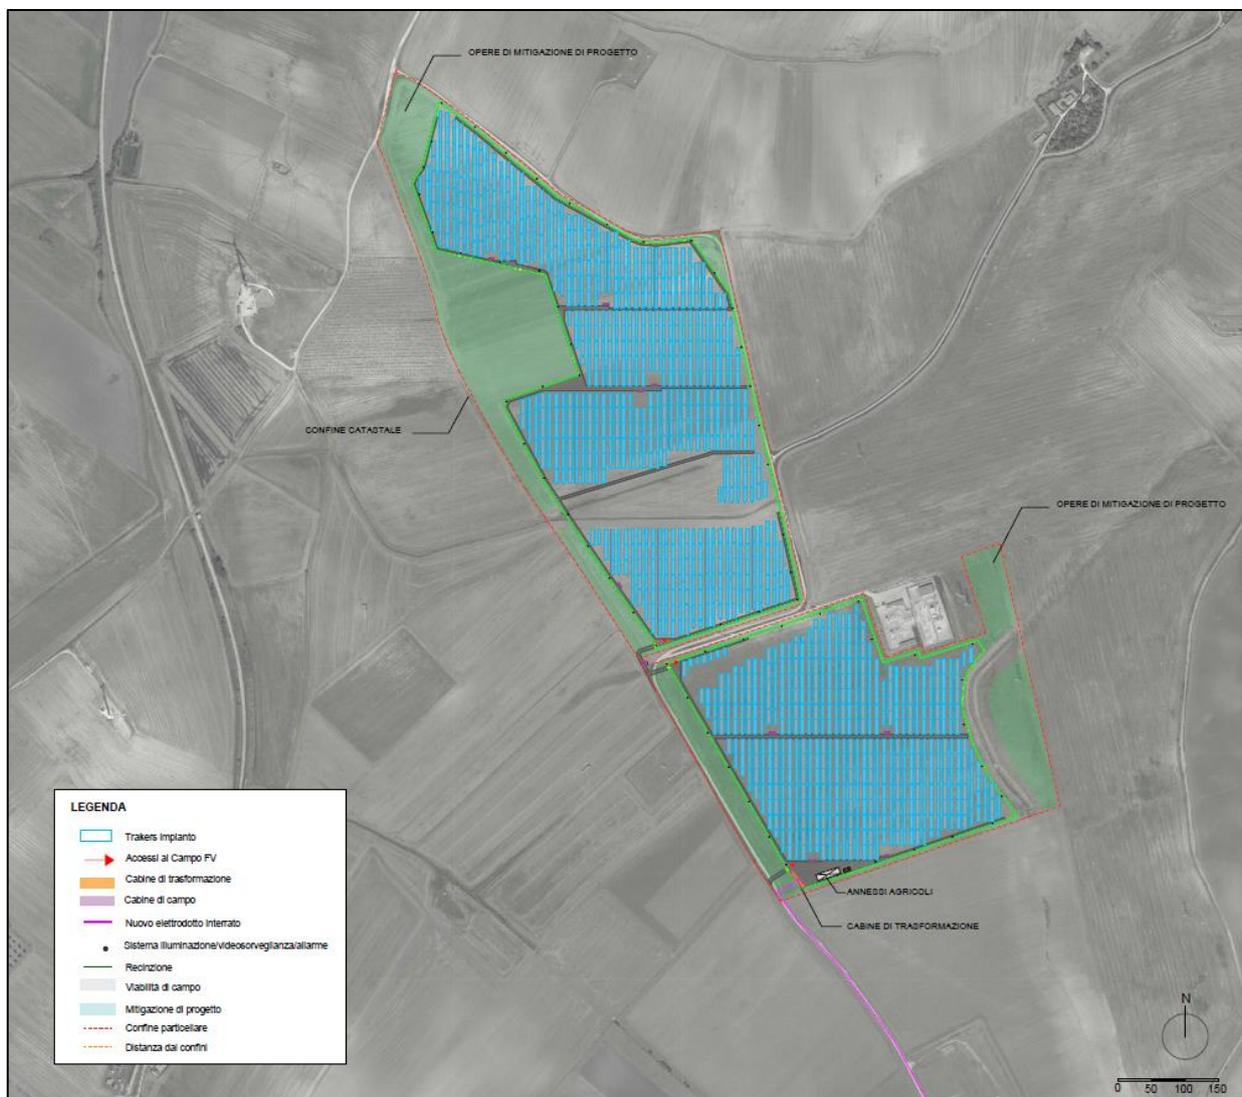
Layout dell'impianto agrivoltaico su ortofoto
